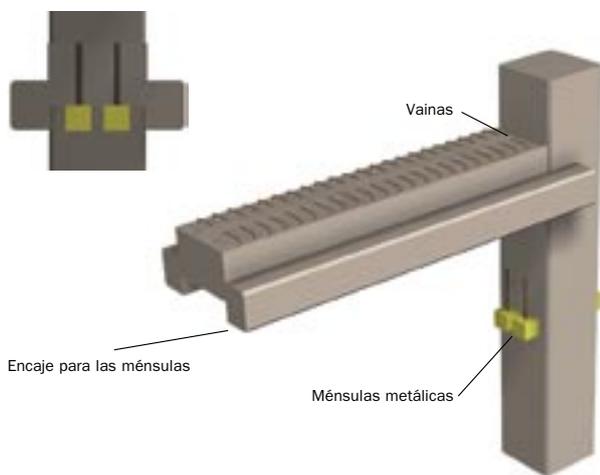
Detalle apoyo de las jácenas con el pilar
